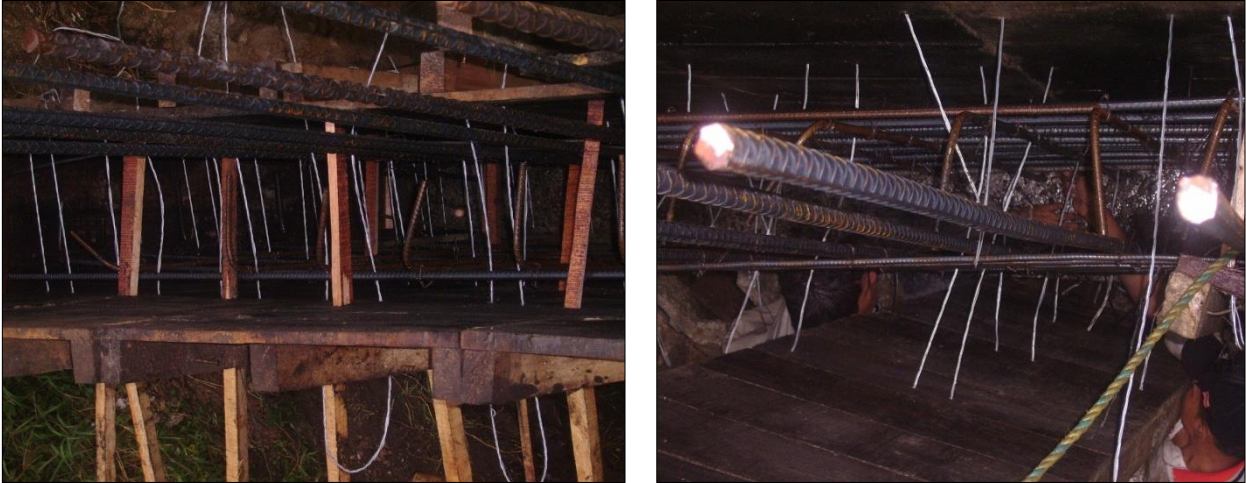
Formaleta y acero de refuerzo, listo para fundición en el muro del estribo. Vista interior.
